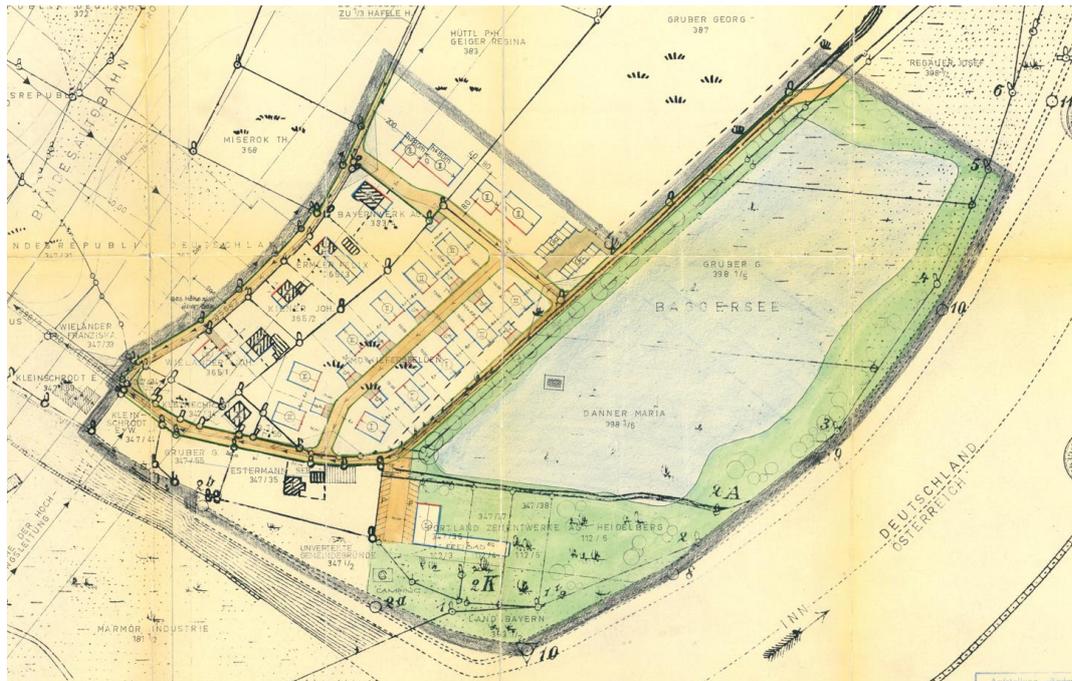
Planzeichnung des Bebauungsplans „Kieferer Wiesen“, ohne Maßstab, 1967
